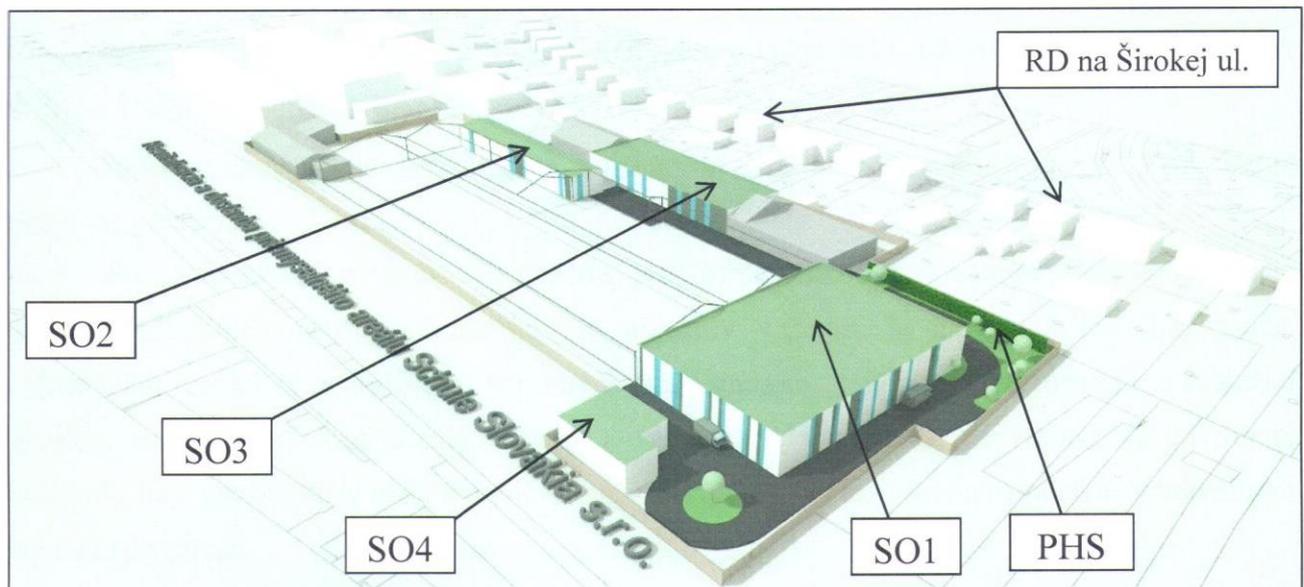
Poloha Schüle Slovakia medzi ulicou Široká a železničnou traťou ŽSR180, v území „Priemyselný obvod – Západ“
